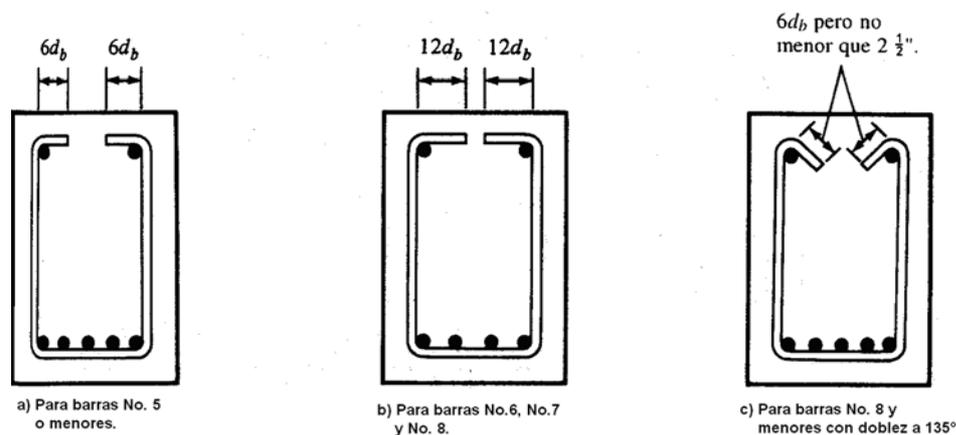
Anclaje del refuerzo transversal de acuerdo a las NTC-2004
